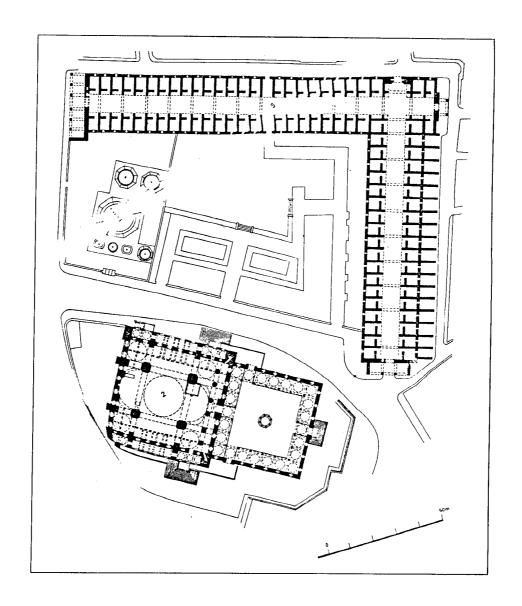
مسقط أفقي لمجمع السليمانية في إستانبول (عن : كوران) .
